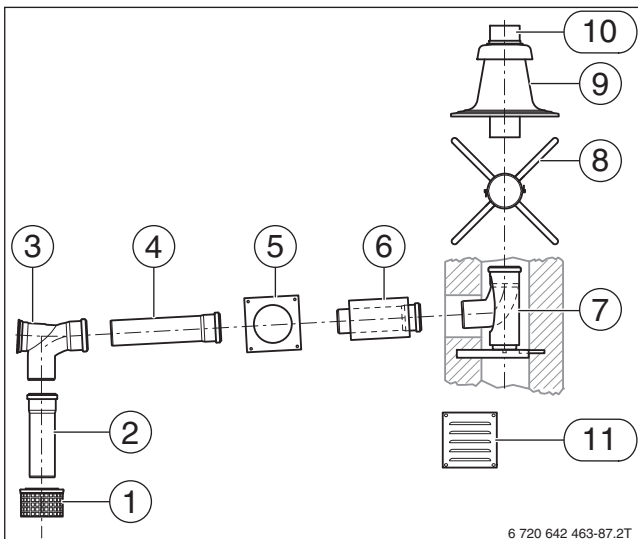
Montagevariante mit dem Bausatz GA + UB-Flex
